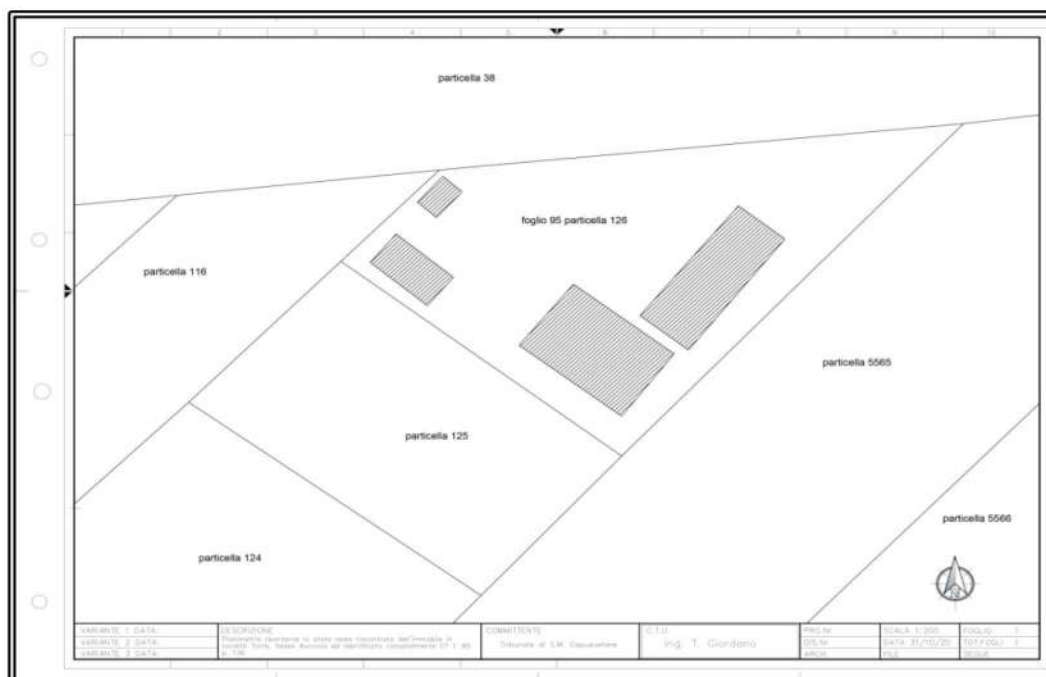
Pianta stato attuale terreno con indicazione dei fabbricati
